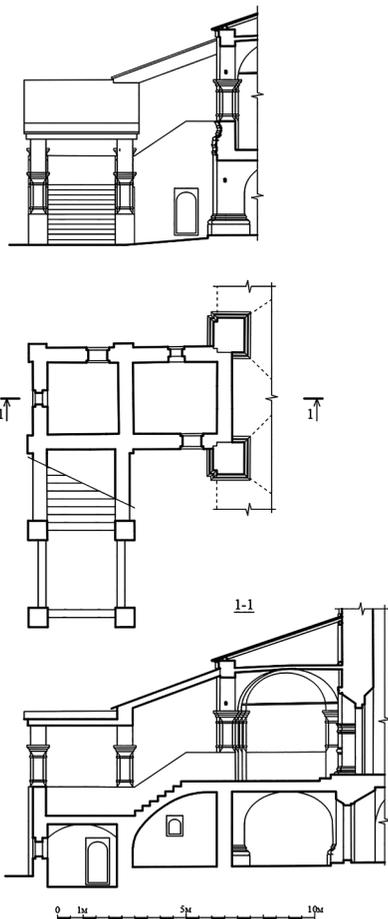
Графическая реконструкция западного крыльца Спасской церкви начала XVI в. Вариант 2. Фасад, план, продольный разрез
